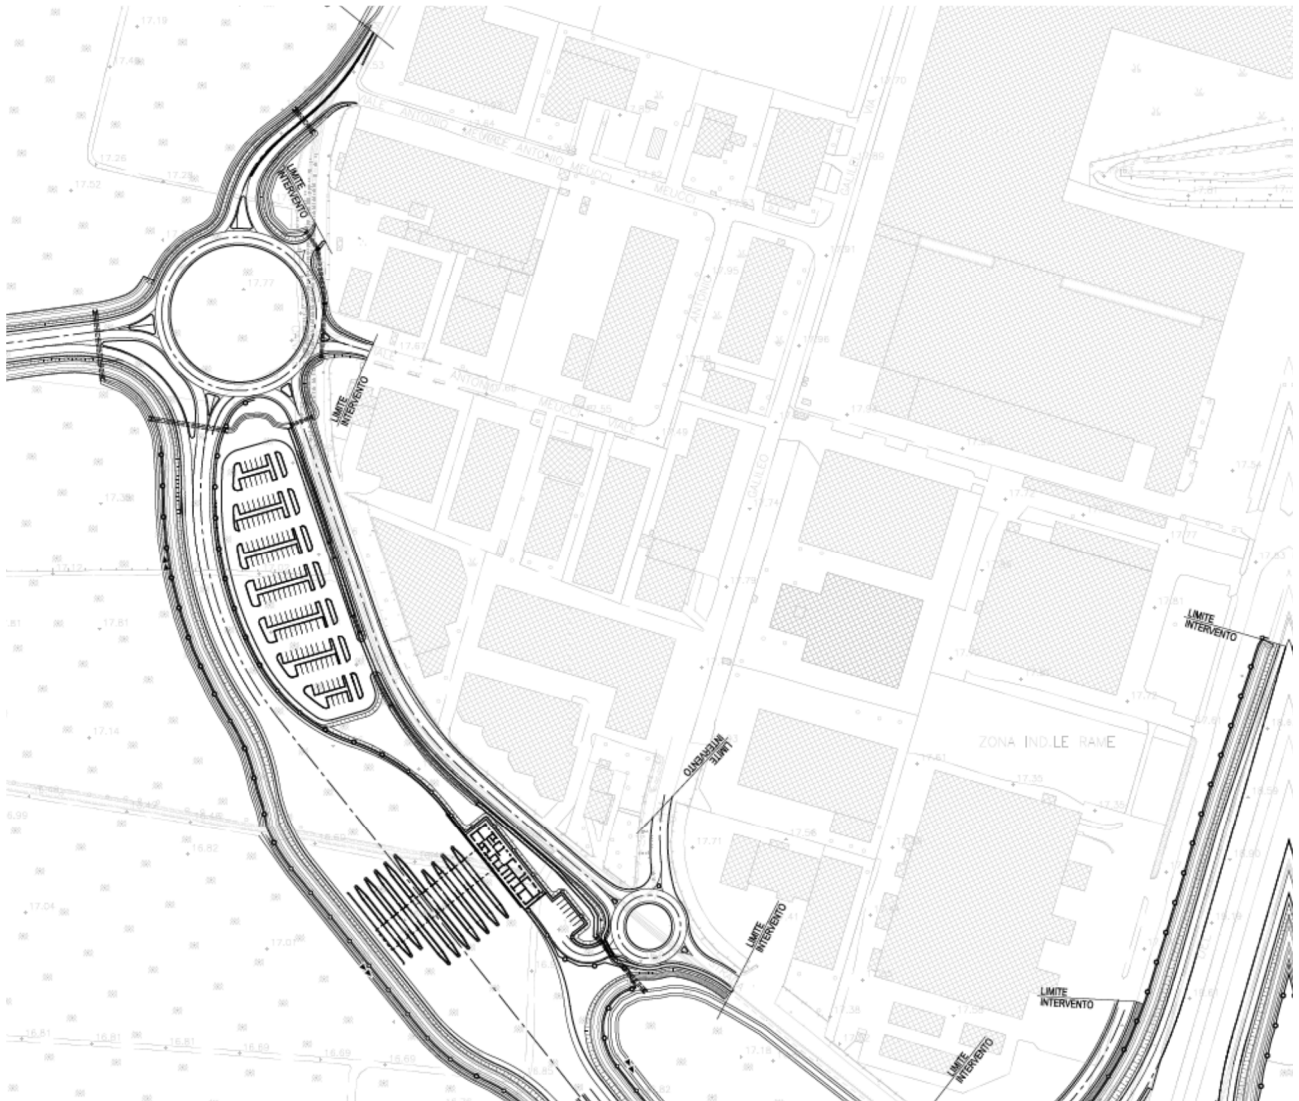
PLANIMETRIA PROGETTO DEFINITIVO
